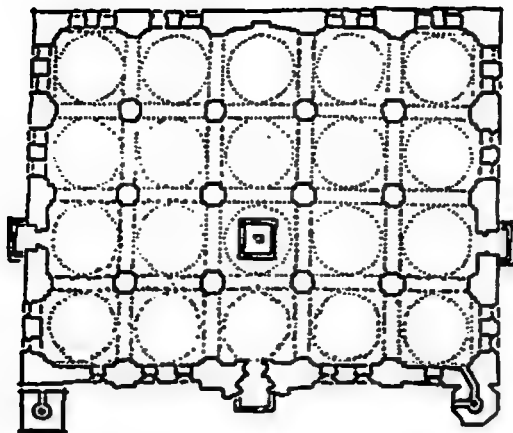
المسقط الأفقي لجامع فيروز آغا .
